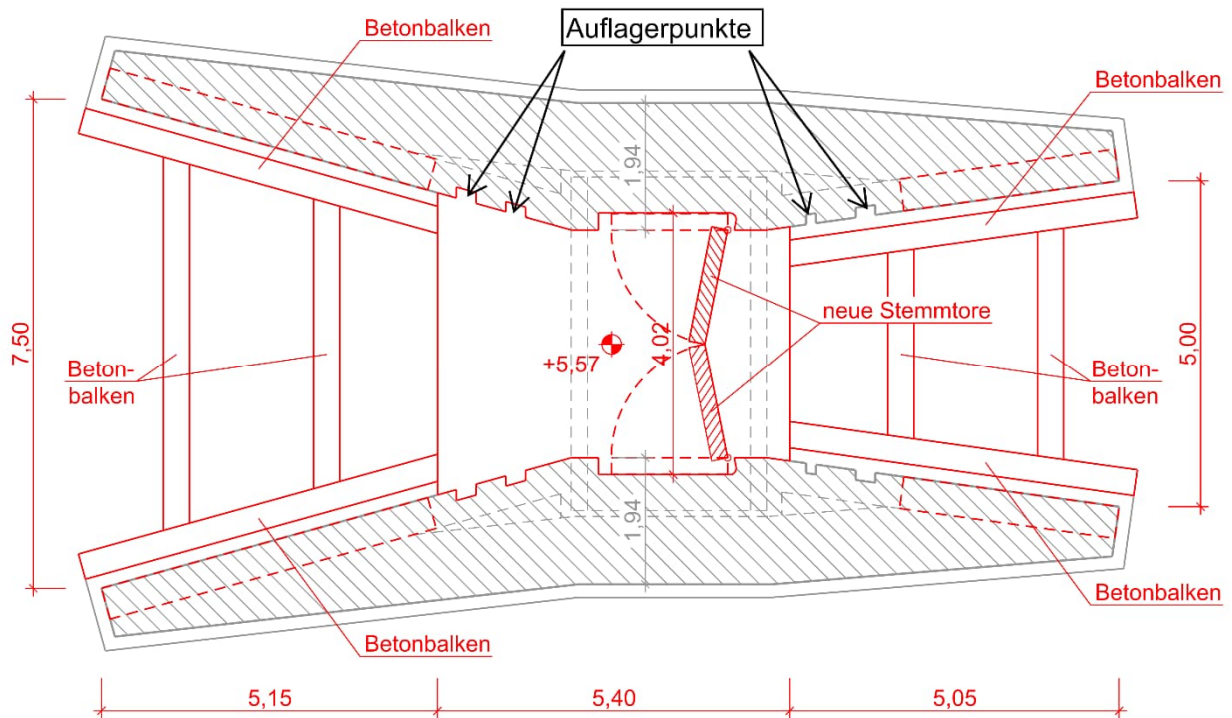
Alternative „Grundinstandsetzung“ – Grundriss (Stand 2023)
